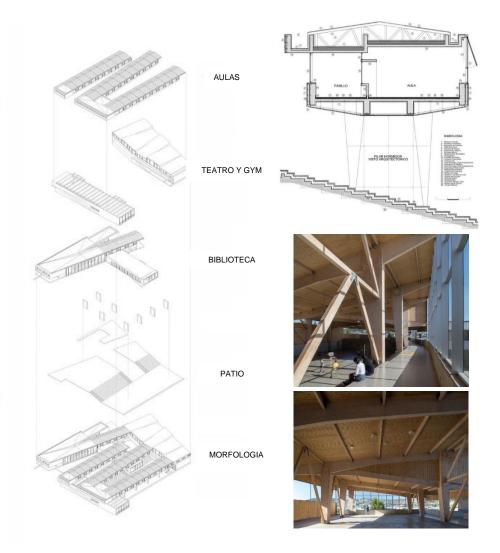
Composición estructural del Liceo Mariano La Torre Fuente: Archidally, 2014
